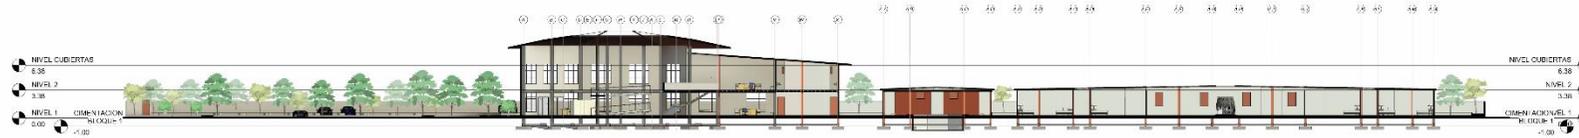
Fachadas Longitudinales & Cortes Transversales.
